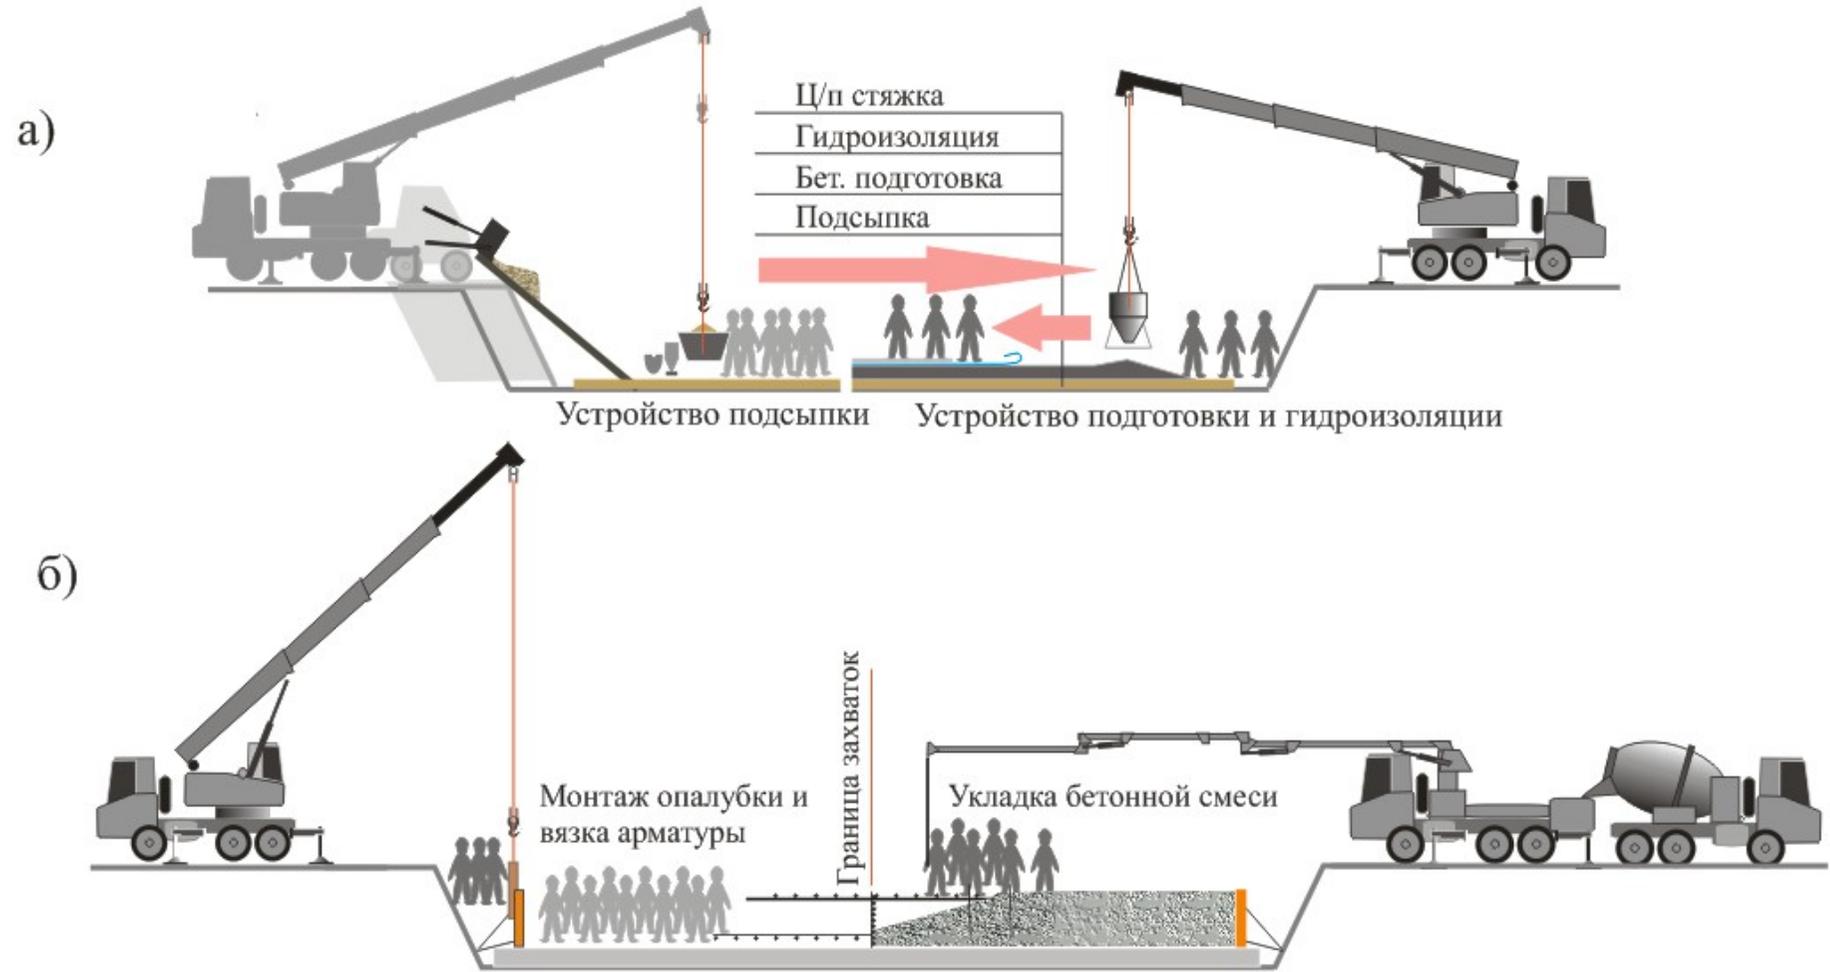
Технологические схемы работ по устройству монолитной ж/б фундаментной плиты
